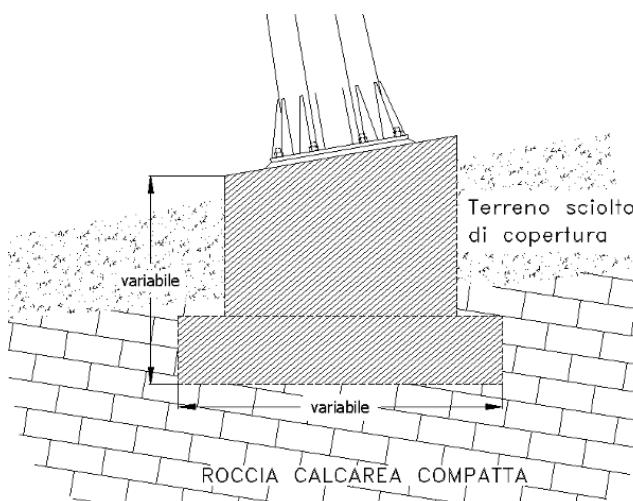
sezione tipo dei plinti di fondazione dei sostegni impostati in roccia.
